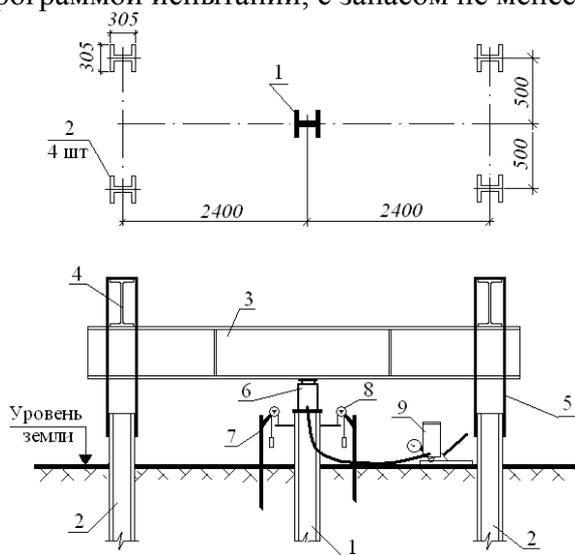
Схема испытания грунтов сваями статическими вертикально-вдавливающими нагрузками: 1 - испытываемая свая; 2 - анкерные сваи; 3 - главная двутавровая балка №70; 4 - второстепенные балки № 40; 5 - анкерные тяжи Ø20АП; 6 - домкрат СМЖ-158А (грузоподъемность 200 т); 7 - реперная систем; 8 - прогибомеры 6ПАО; 9 - ручная насосная станция с манометром.
